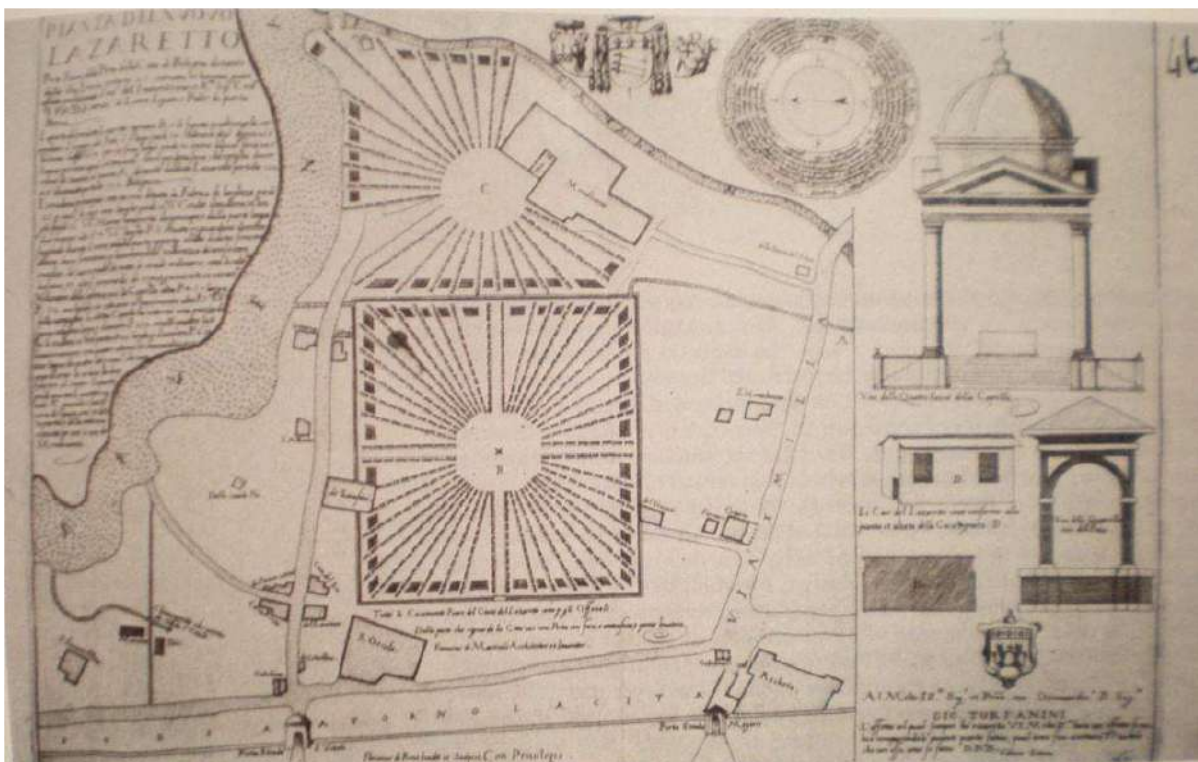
Pianta del Lazzaretto nell'area dello Spedale Sant'Orsola, 1630.
